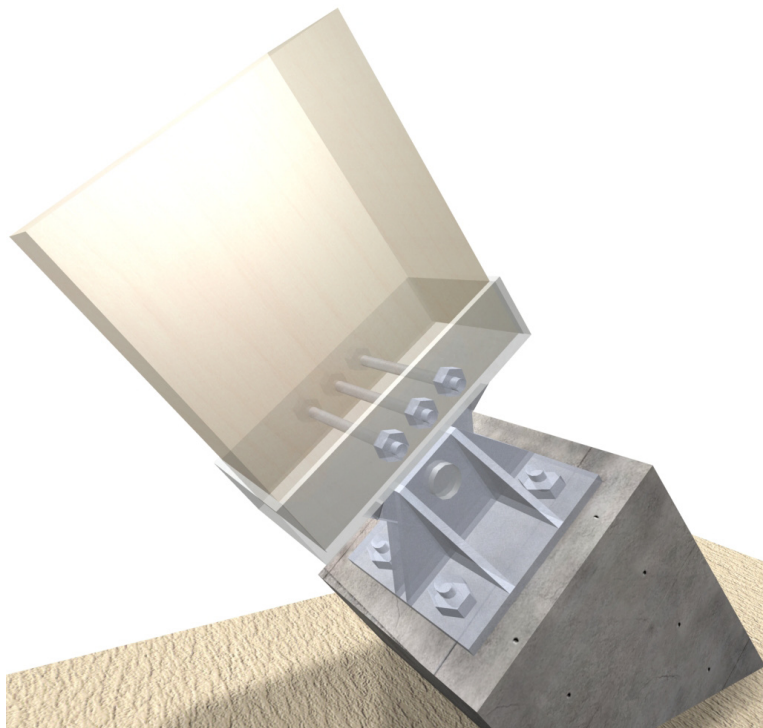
DETALLES DE ANCLAJES Y HERRAJES EN SISTEMA CONSTRUCTIVO DE MADERA LAMINADA. Fuente imágenes: www.plataformaarquitectura.cl
